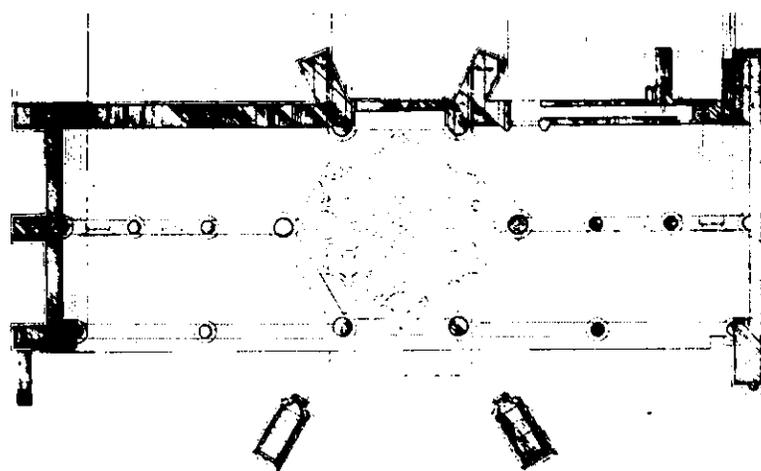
Planta de la capilla abierta de Teposcolula para proyecto de restauración, 1995 (López).
